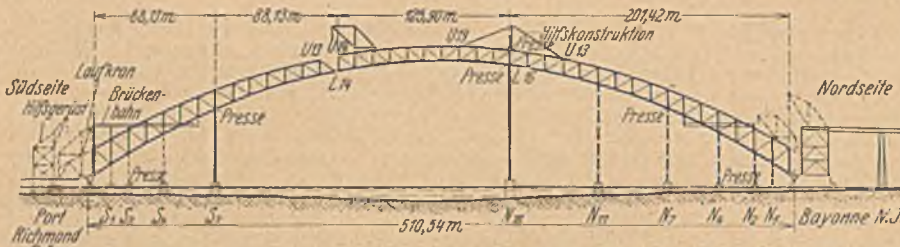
Kill van Kull-Brücke. Herstellung des Bogens mit Unterstützung durch Gerüste.
